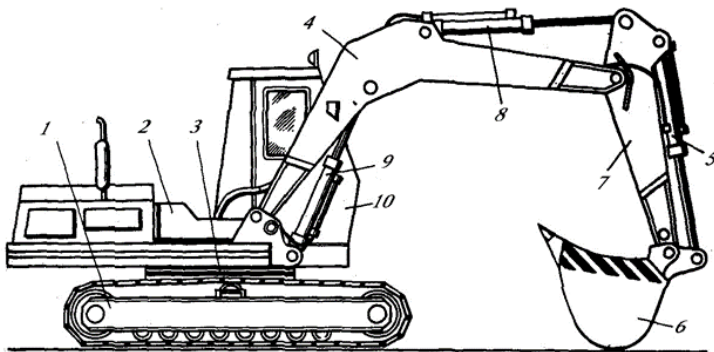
Одноковшовый гидравлический экскаватор: 1 – ходовое устройство; 2 – поворотная часть; 3 – опорно-поворотное устройство; 4 – стрела; 5, 8 и 9 – гидроцилиндры; 6 – ковш; 7 – рукоять; 10 – кабина
